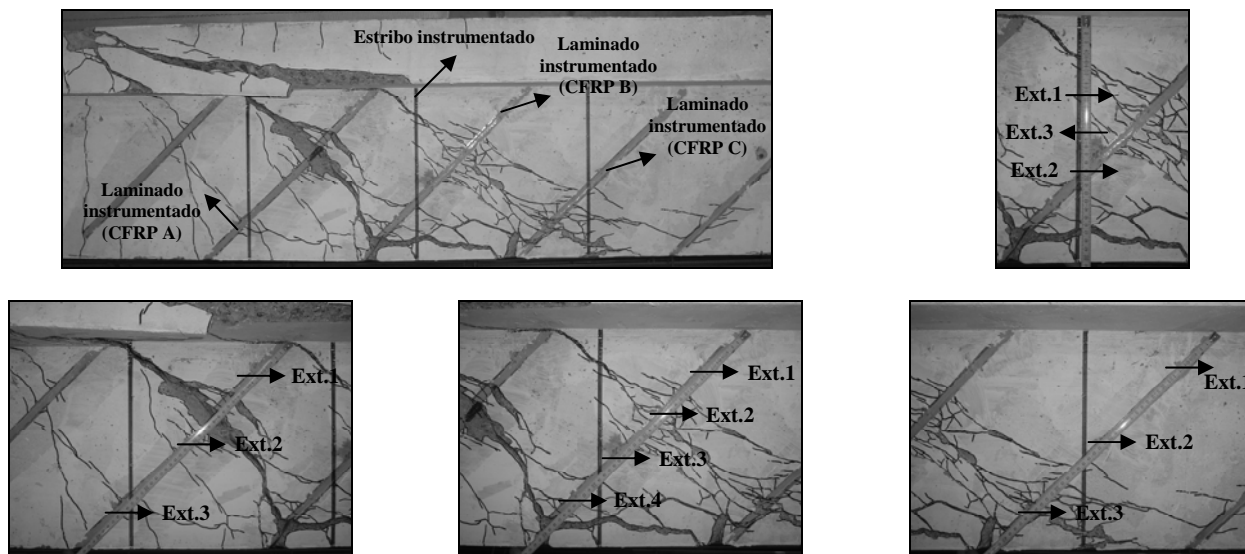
Localização dos extensómetros no laminado e estribo instrumentados da viga 3S-5LI45-D.
